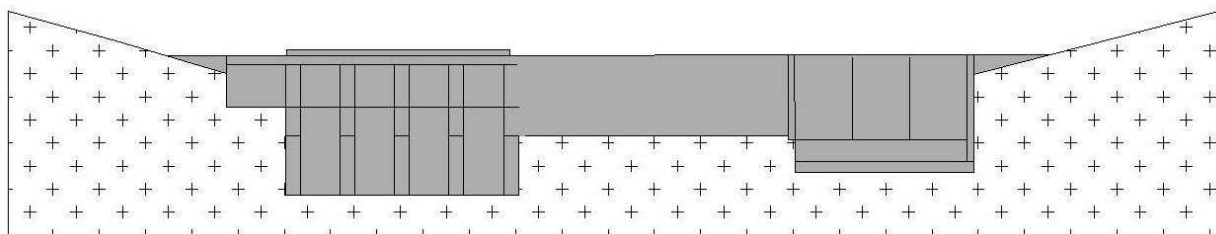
Поперечный разрез плотины на втором этапе строительства
